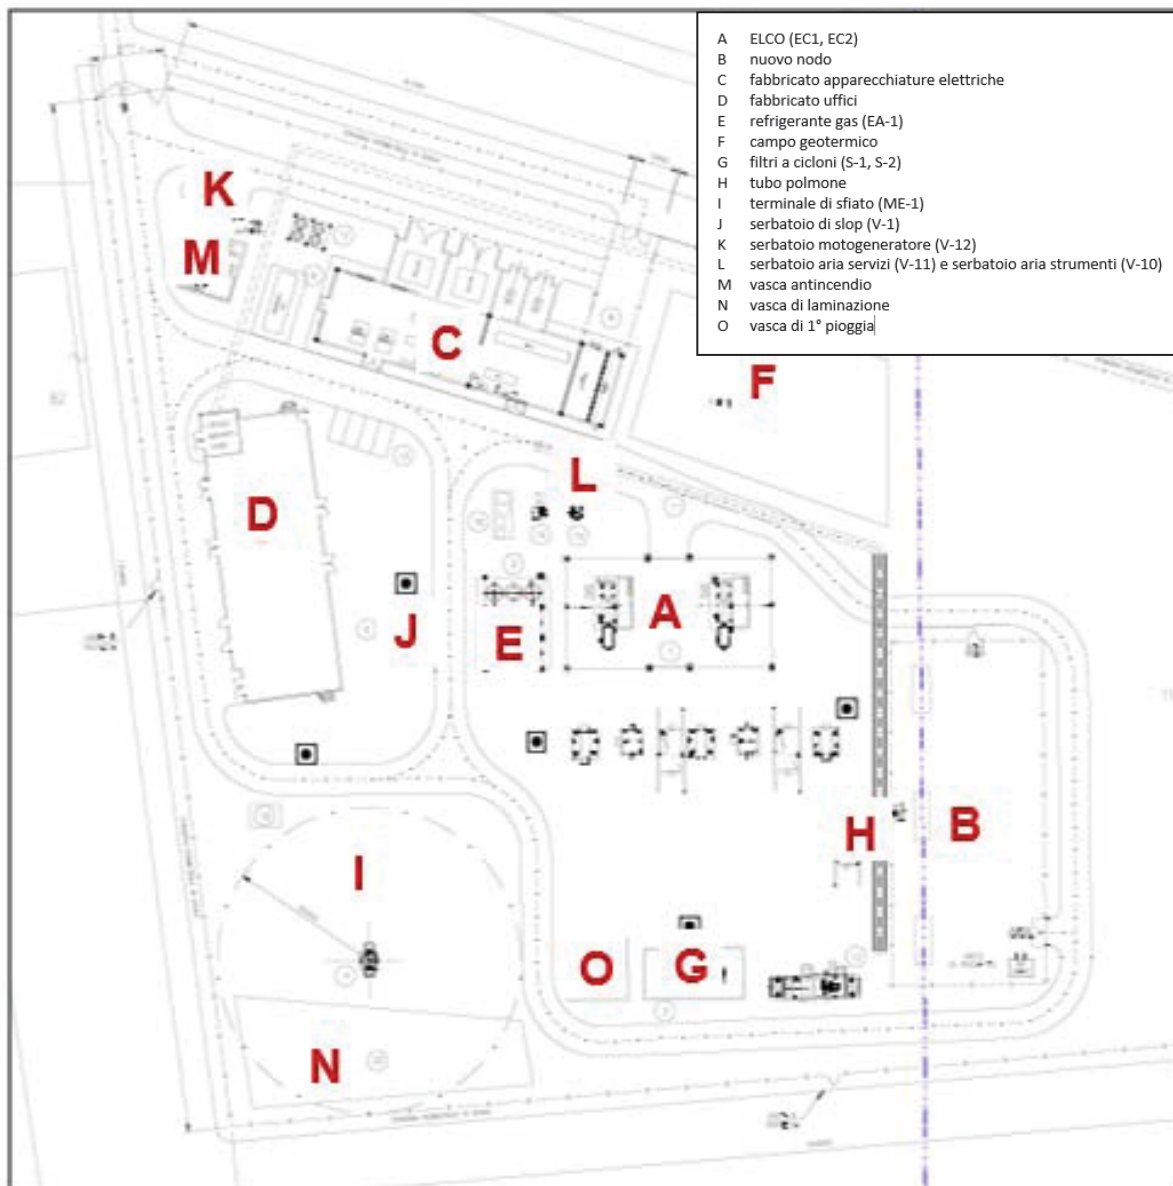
Estratto della planimetria generale dell'impianto
